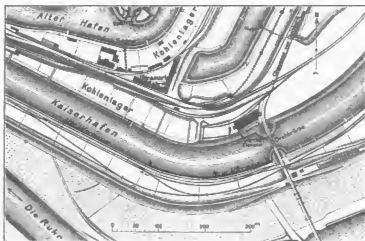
Lageplan der Ufermauer am Kaiserhafen von Ruhrort.
